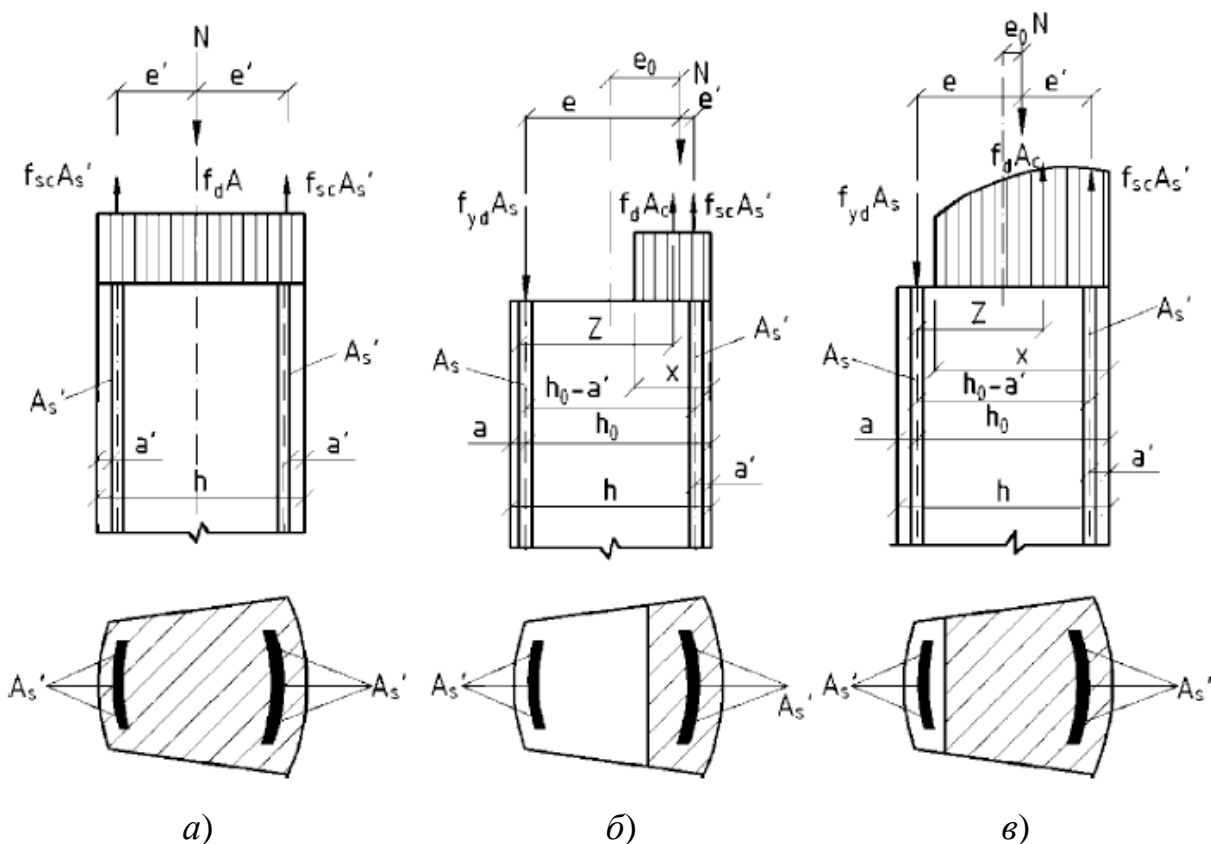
Розрахункові схеми кладки з поздовжнім армуванням:
